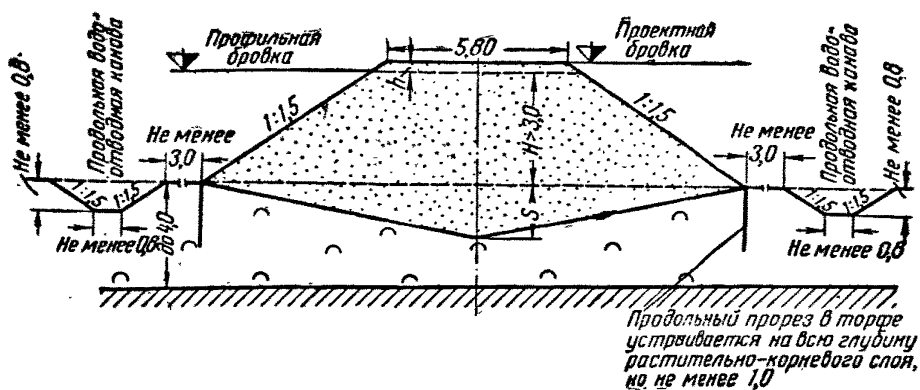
Насыпь высотой более 3 м из дренирующих грунтов на болоте I типа без выторфовывания при поперечном уклоне минерального дна болота не круче 1:10
